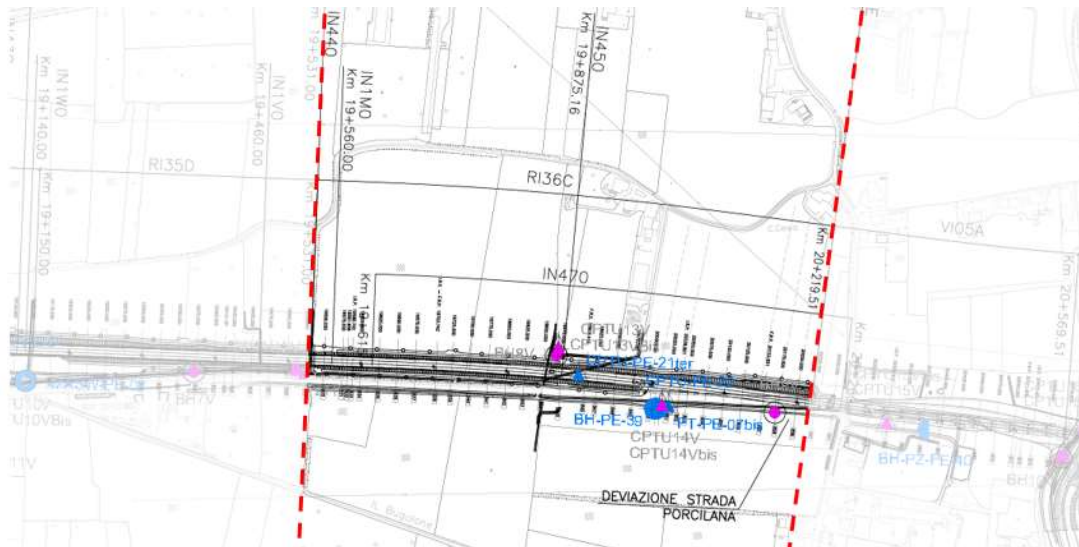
Planimetria Rilevato RI36C, estratto dalla Planimetria Generale (Doc. Rif. [7])
